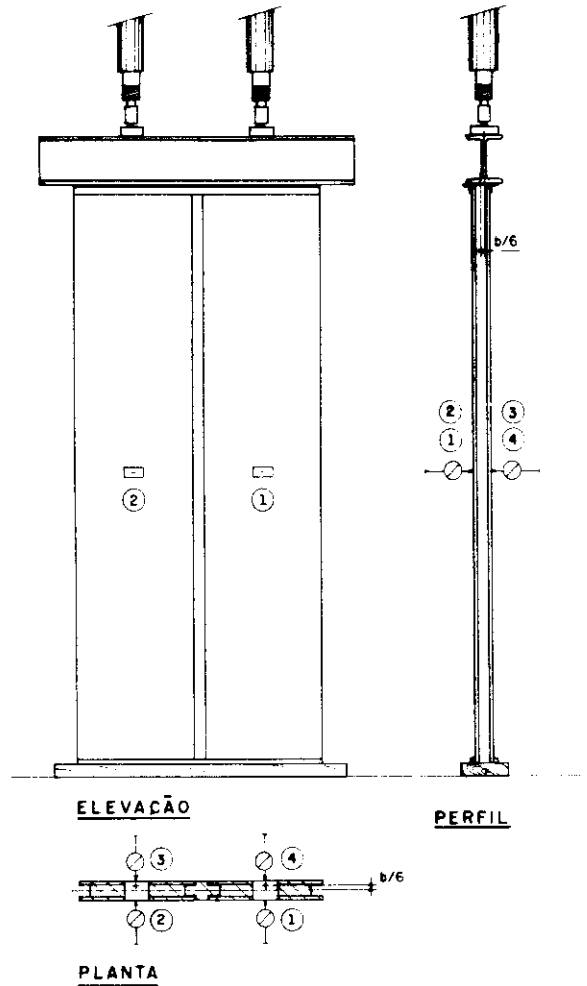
ESQUEMA DO ENSAIO DE PAINEL PORTANTE SUBMETIDO A CARREGAMENTO VERTICAL EXCÊNTRICO.
